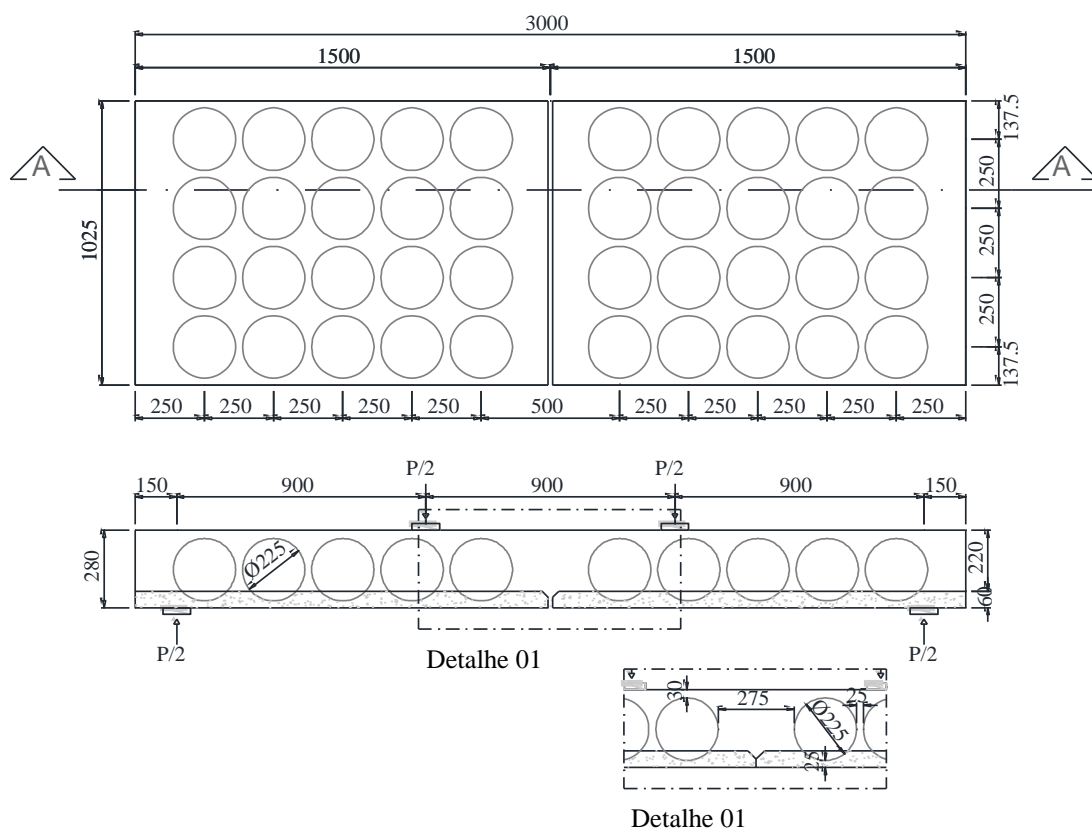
Laje *BubbleDeck* BD28-F3 (dimensões em mm)
